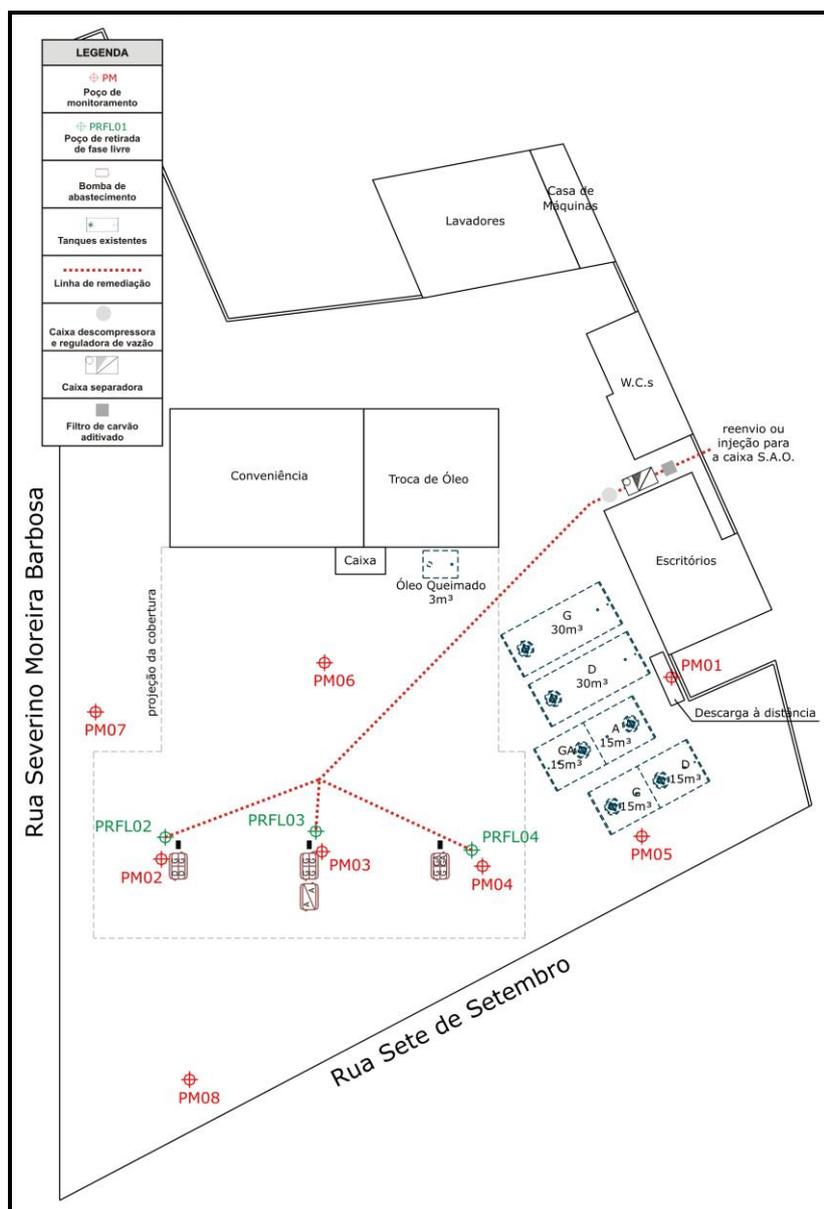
Planta do sistema de remediação por bombeamento e tratamento, implantado na área do auto posto Therezinha da Silva Pontes, em Cachoeira Paulista (SP).
